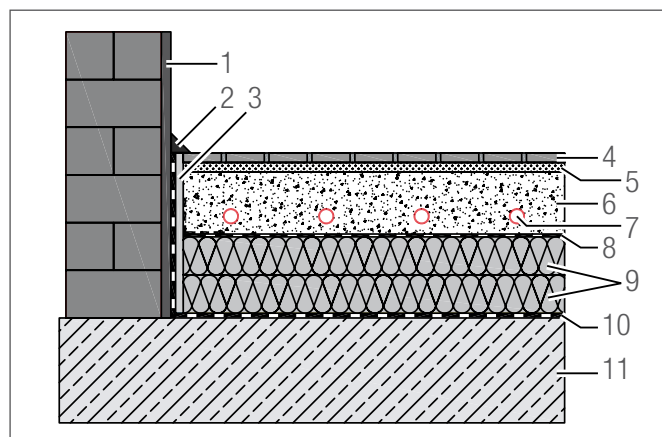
Exemplu de structură pardoseală pentru sistemele de încălzire cu șapă umedă
